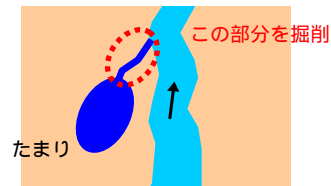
タナゴパラダイスの施工平面（イメージ図）
